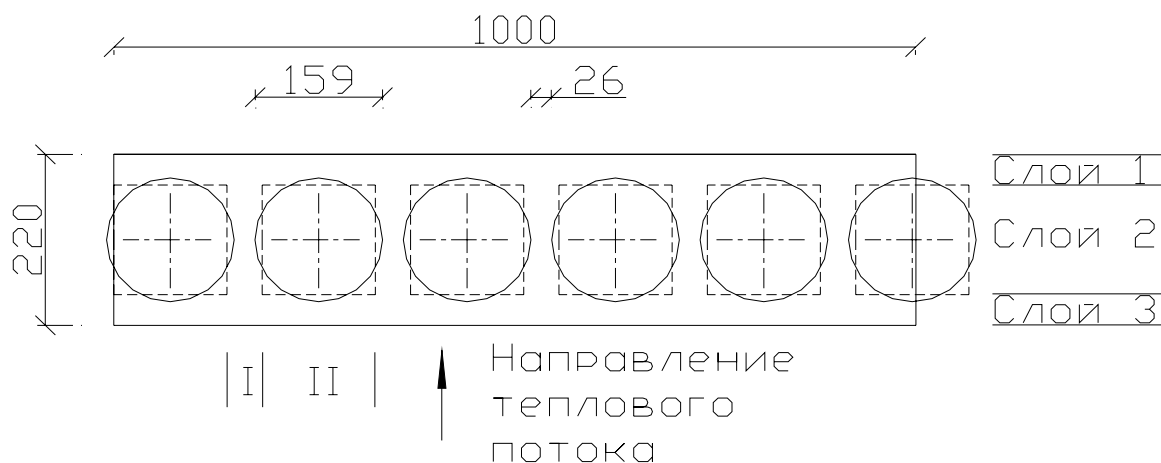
Конструкция многопустотной железобетонной плиты перекрытия
